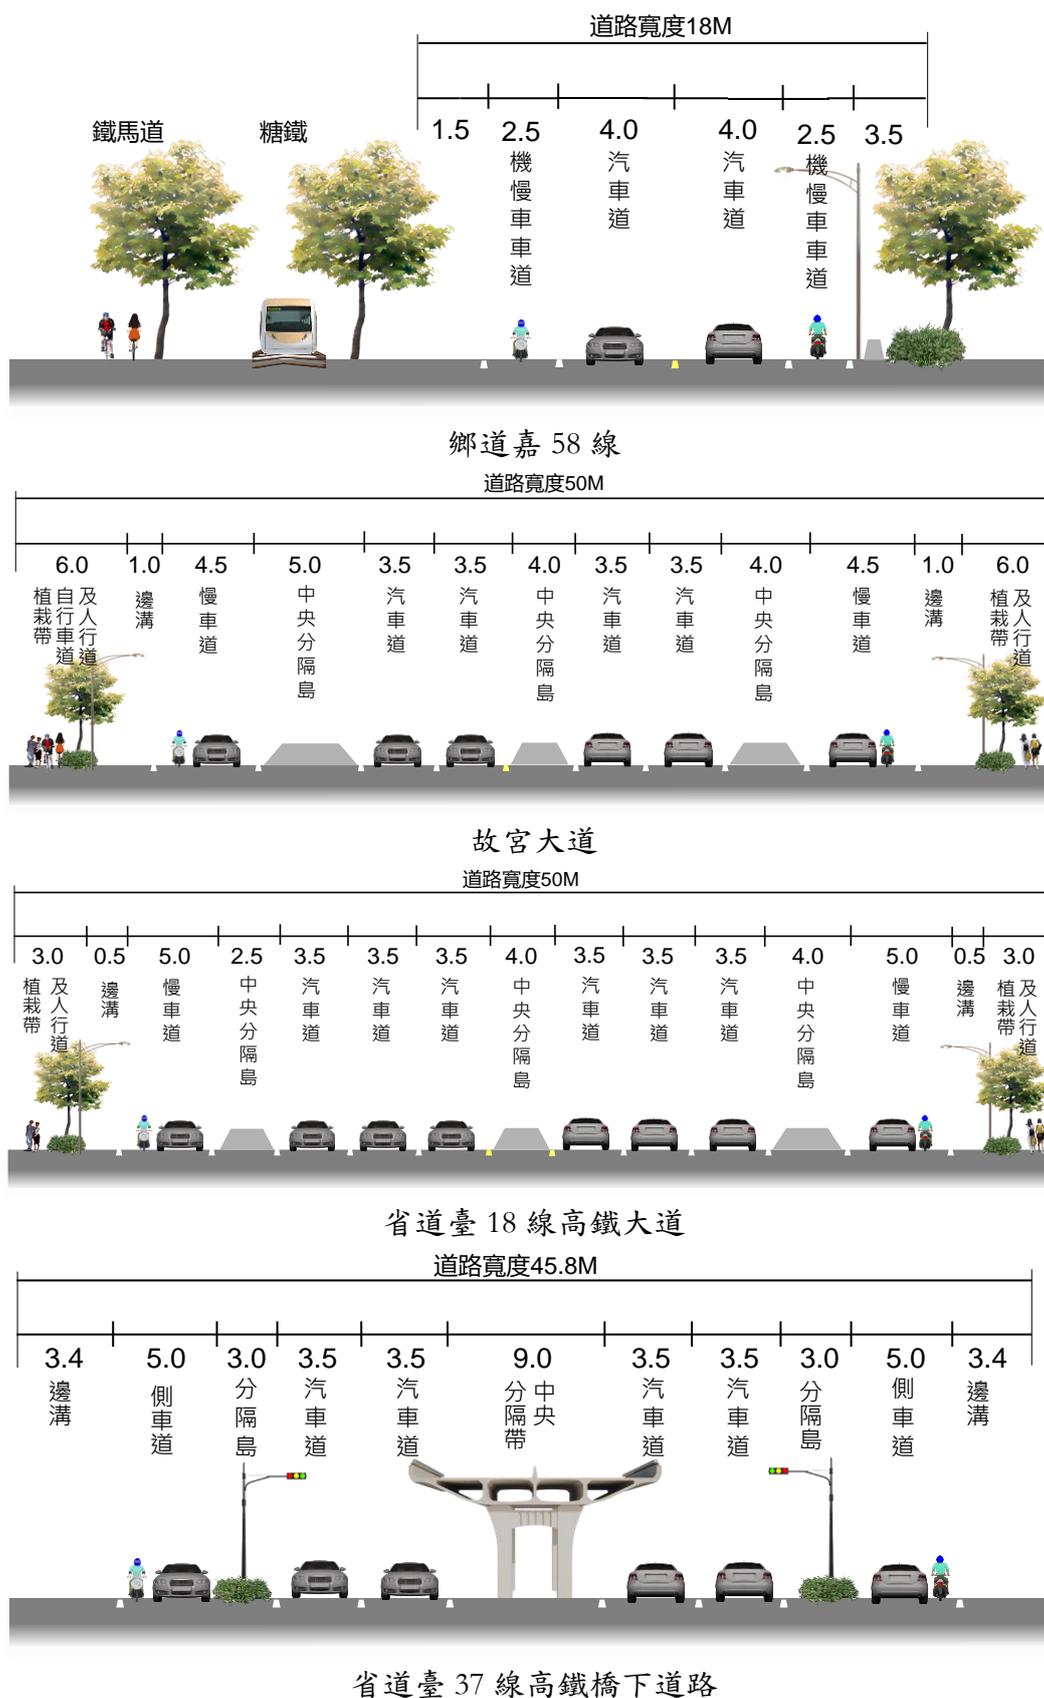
基地周邊道路現況道路斷面配置圖
